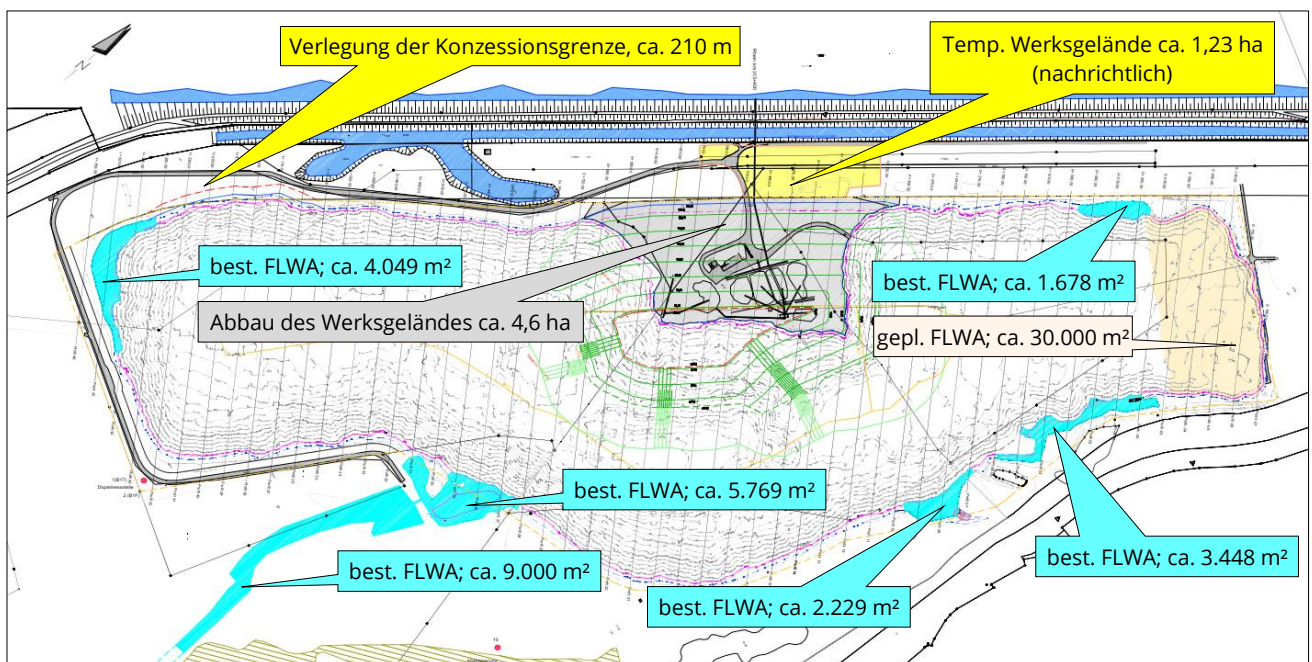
Übersichtslageplan der Abbauplanung mit Flachwasserzonen (siehe auch Anlage 2.1)
